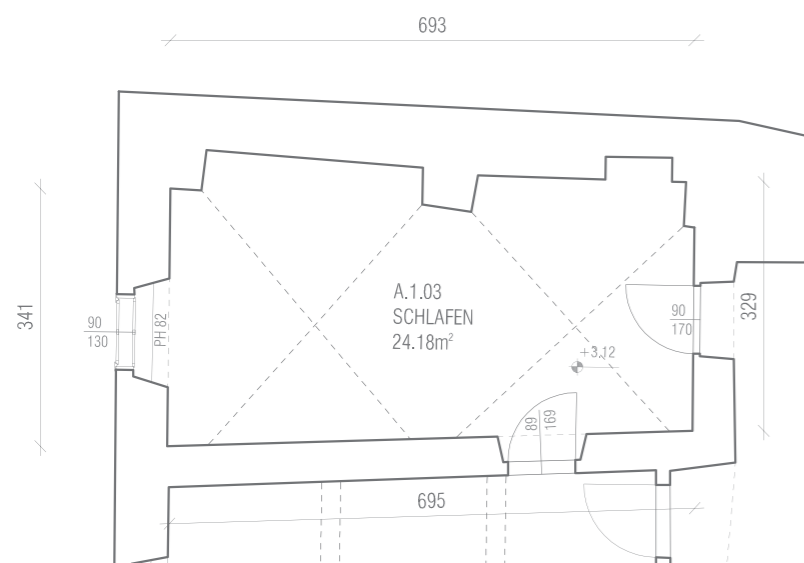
Grundriss Raum A.1.03_1:100
